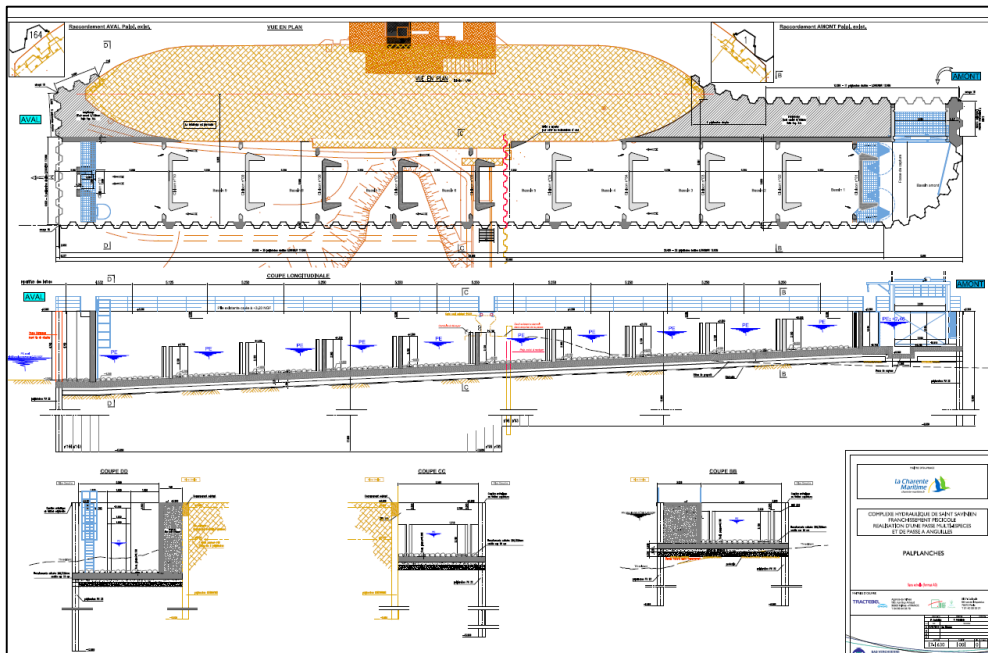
Plan en coupe longitudinale de la passe multispécifique
